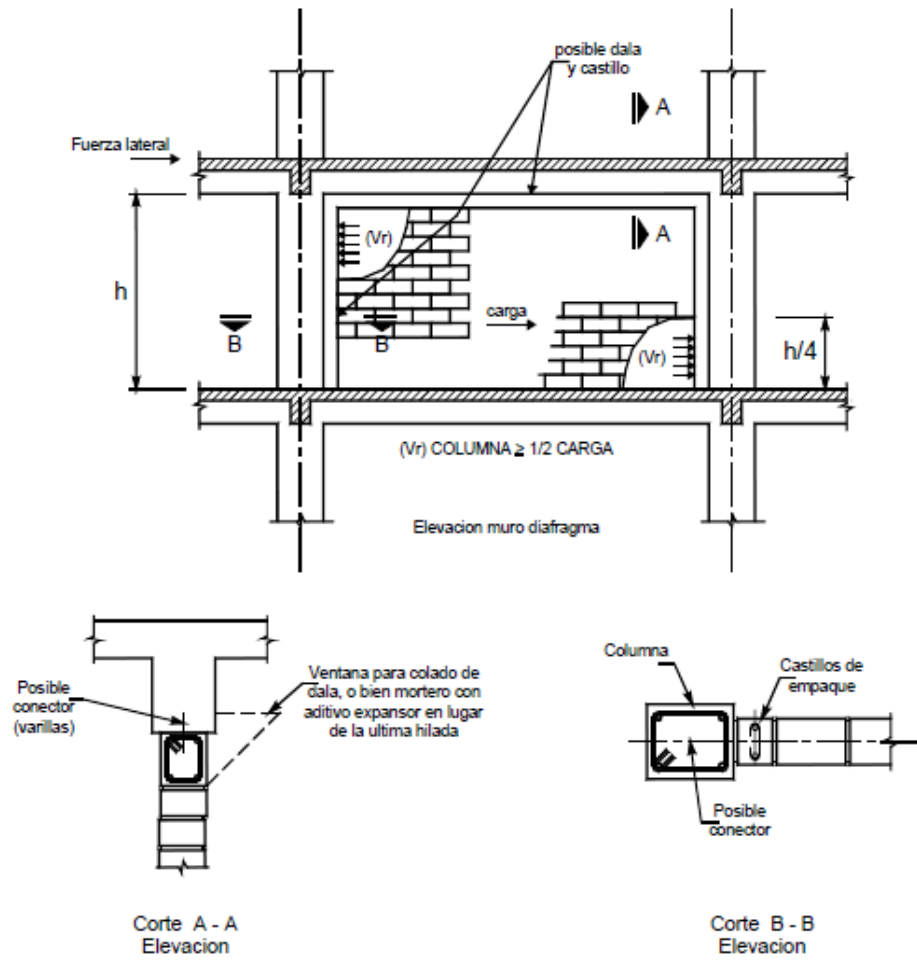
Detalles en planta y elevación de un muro diafragma. (NTCDF, 2004)
